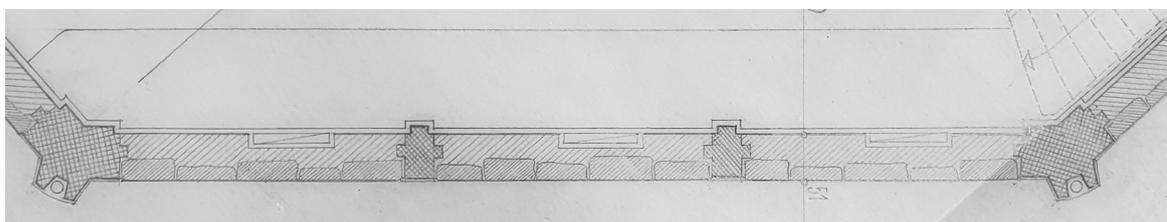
Detailgrundriss mit Betonskelett & Ausfuchung Sandstein Aussen und Füllung in Backstein
